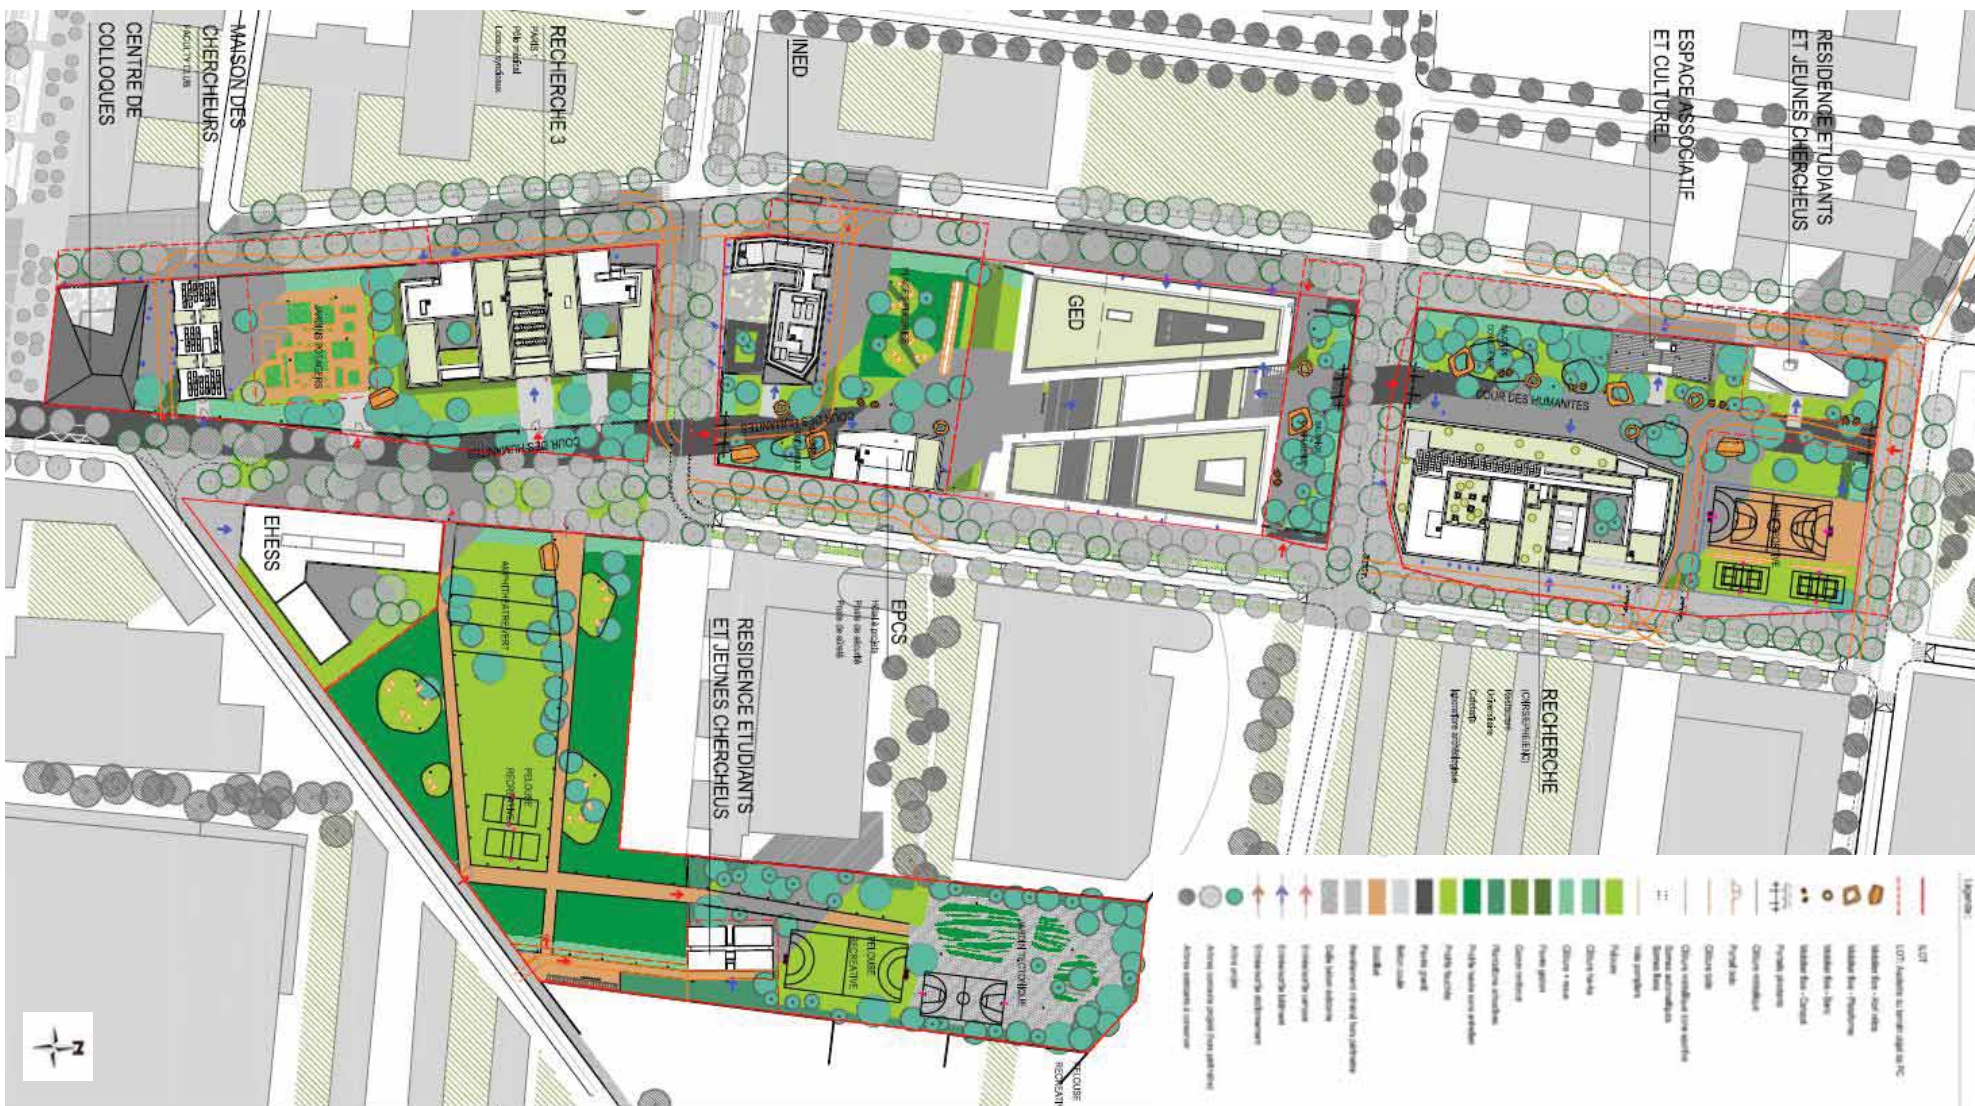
Plan Masse du Campus Condorcet (Source : GROUPEMENT)
